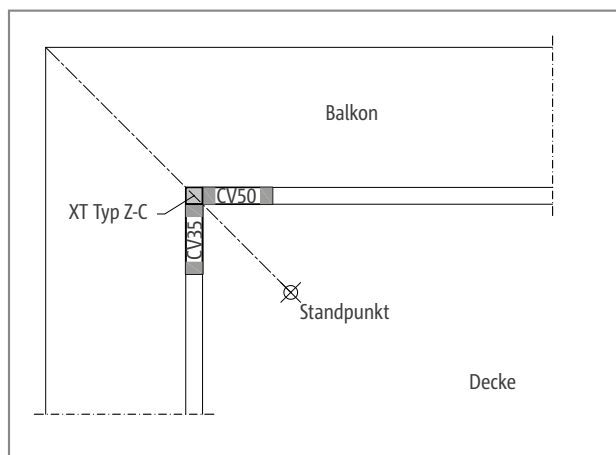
Schöck Isokorb® XT Typ C: Betondeckung wählbar: Hier CV35 links vom Standpunkt, Betondeckung CV50 rechts vom Standpunkt
